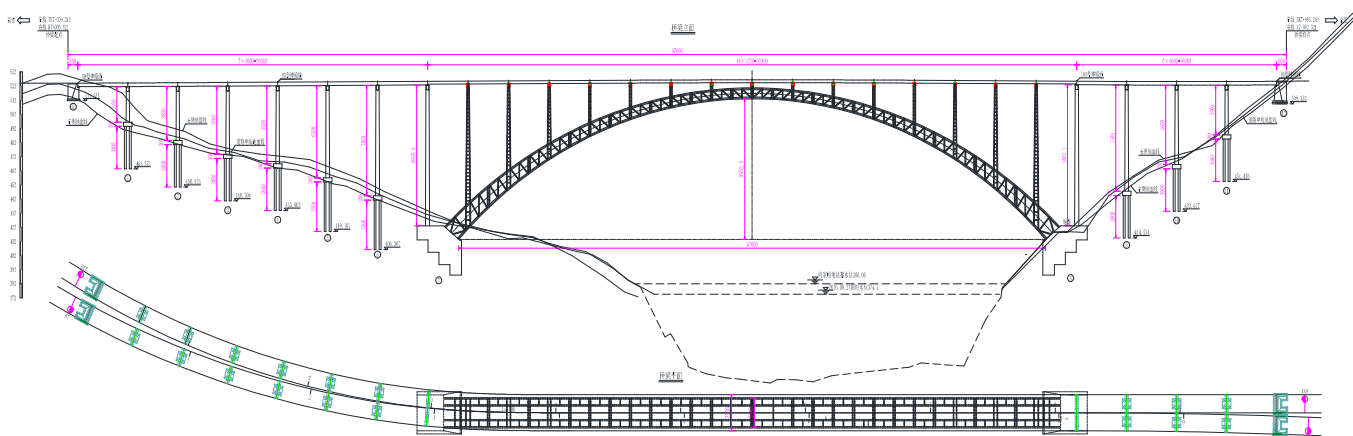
西宁河大桥 470m 钢管混凝土拱桥方案孔跨布置图
